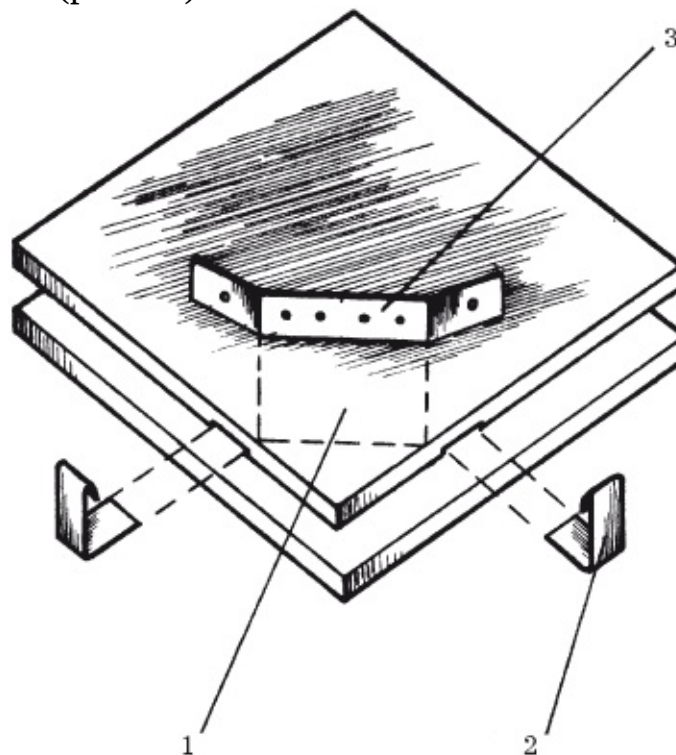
Подготовка плиток для устройства потолка: 1 – облицовочная плитка; 2 – закладные крюки; 3 – крепежная скоба
